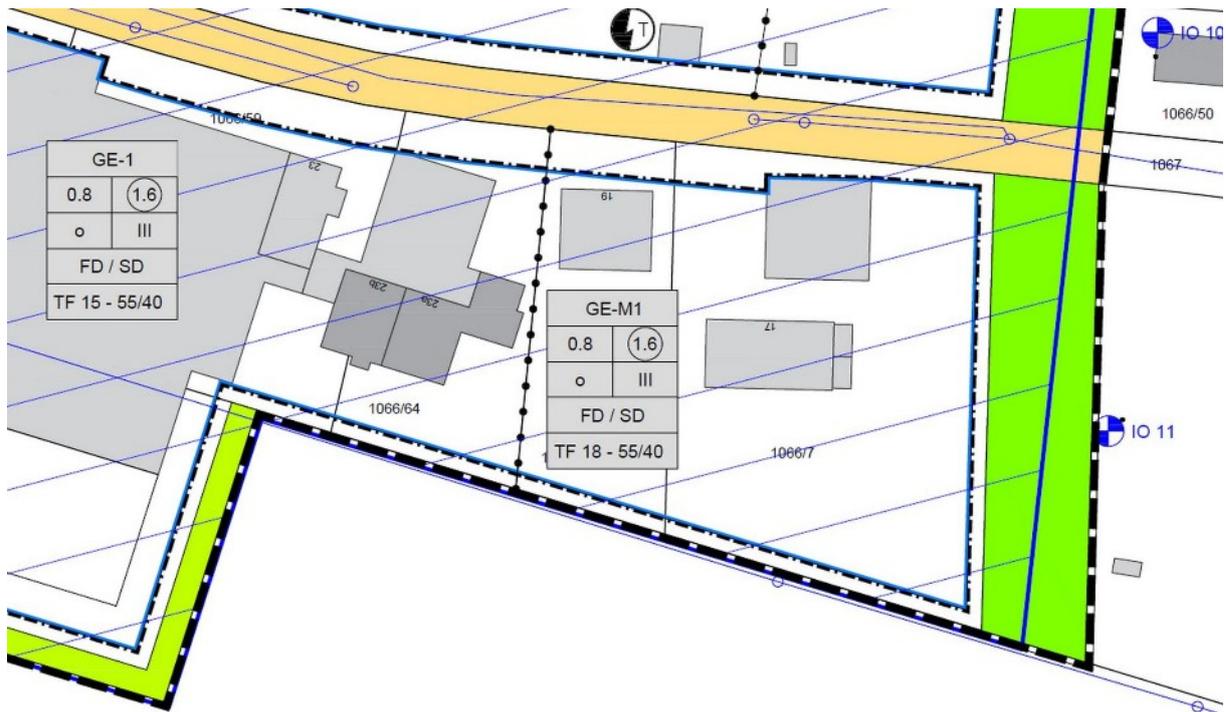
Ausschnitt des BBP W 20 Gewerbegebiet West, zweite Änderung, unmaßstäblich
